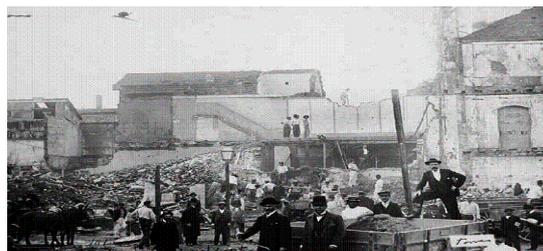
Demolições para a construção da avenida Central, 1904-1905.
